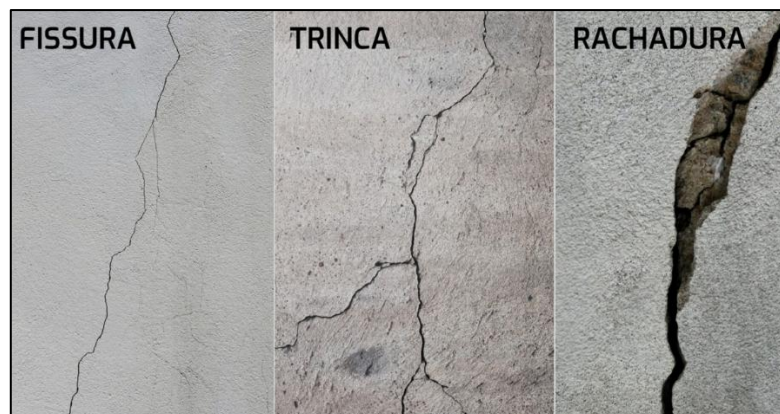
Fissura. Fonte: Fissuras, trincas e rachad <https://www.dallminas.com.br/fissuras-trincas-e-rachaduras/uras> - Dallminas
